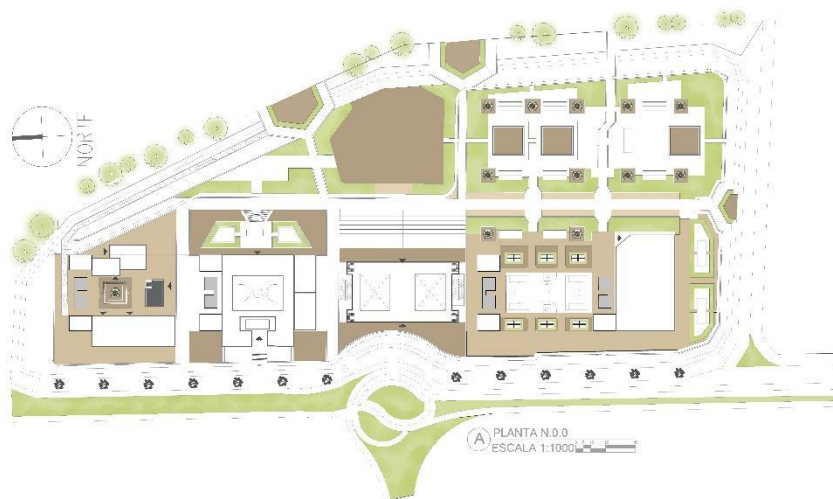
Zonas duras y blandas. En este se evidencian las plazoletas propuestas con las zonas verdes del parque. Elaboración propia
